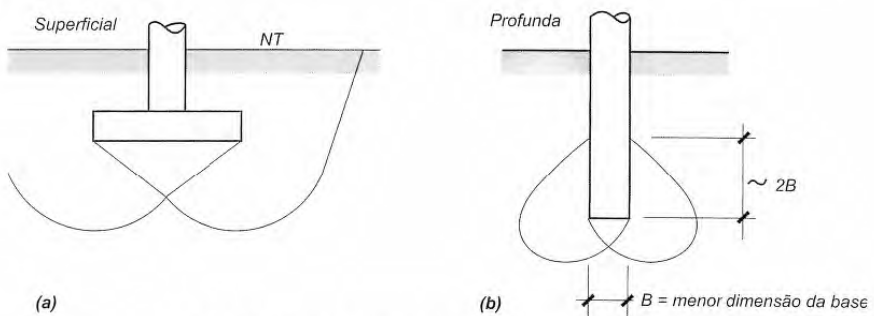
a) Fundação superficial; b) Fundação Profunda.
